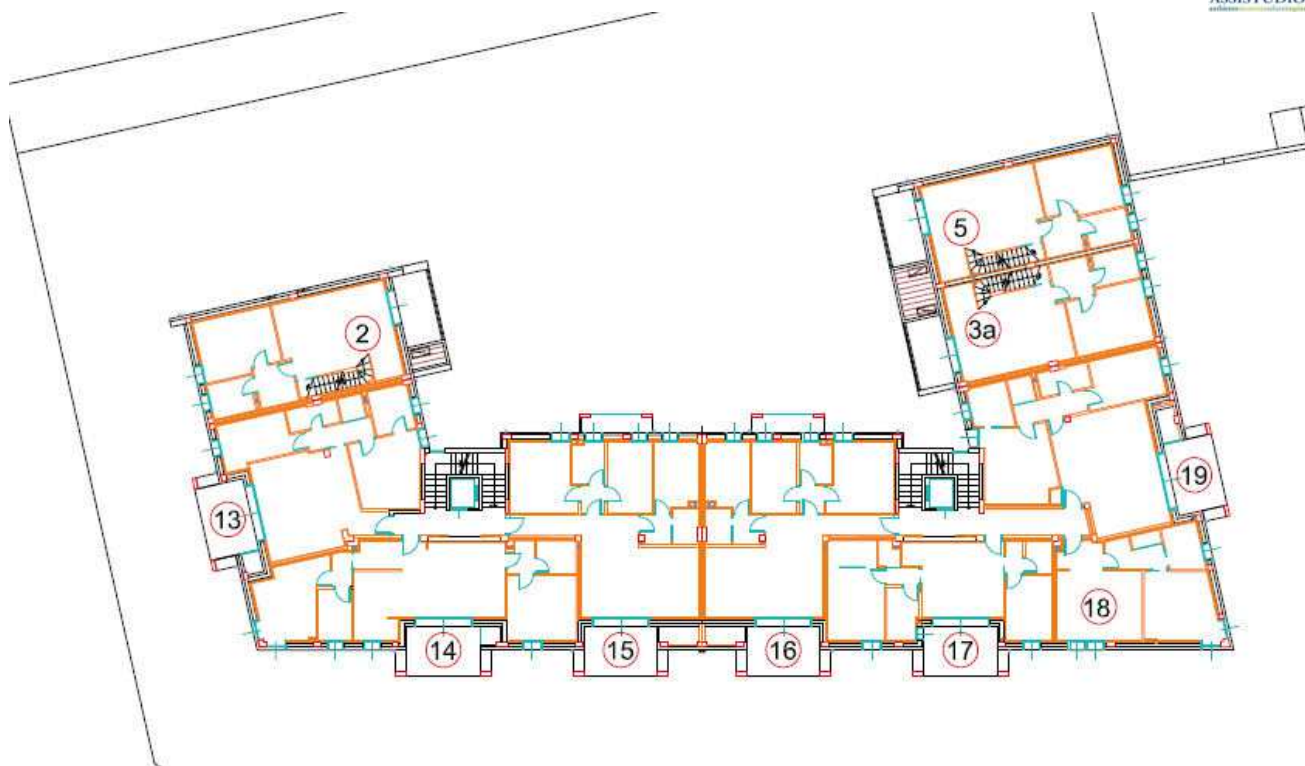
B STATO DI PROGETTO –PIANO PRIMO
